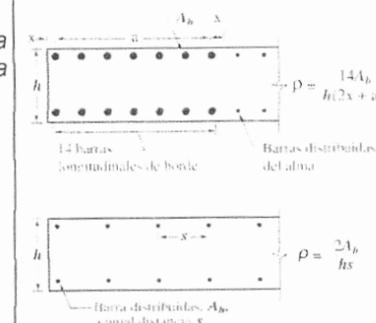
Figura R21.7.6.5 en ACI 318-08. Definición de la cuantía local de refuerzo longitudinal para condiciones de borde típicas en muros.
